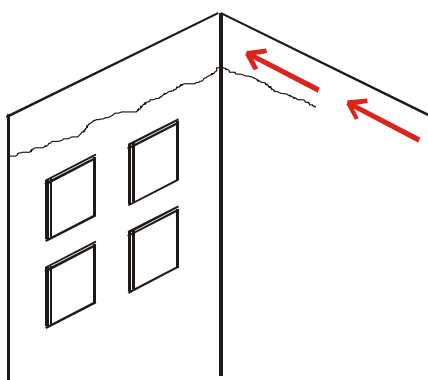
fissura horizontal na interface entre a laje e a parede por movimentação térmica da laje (DUARTE, 1998)
